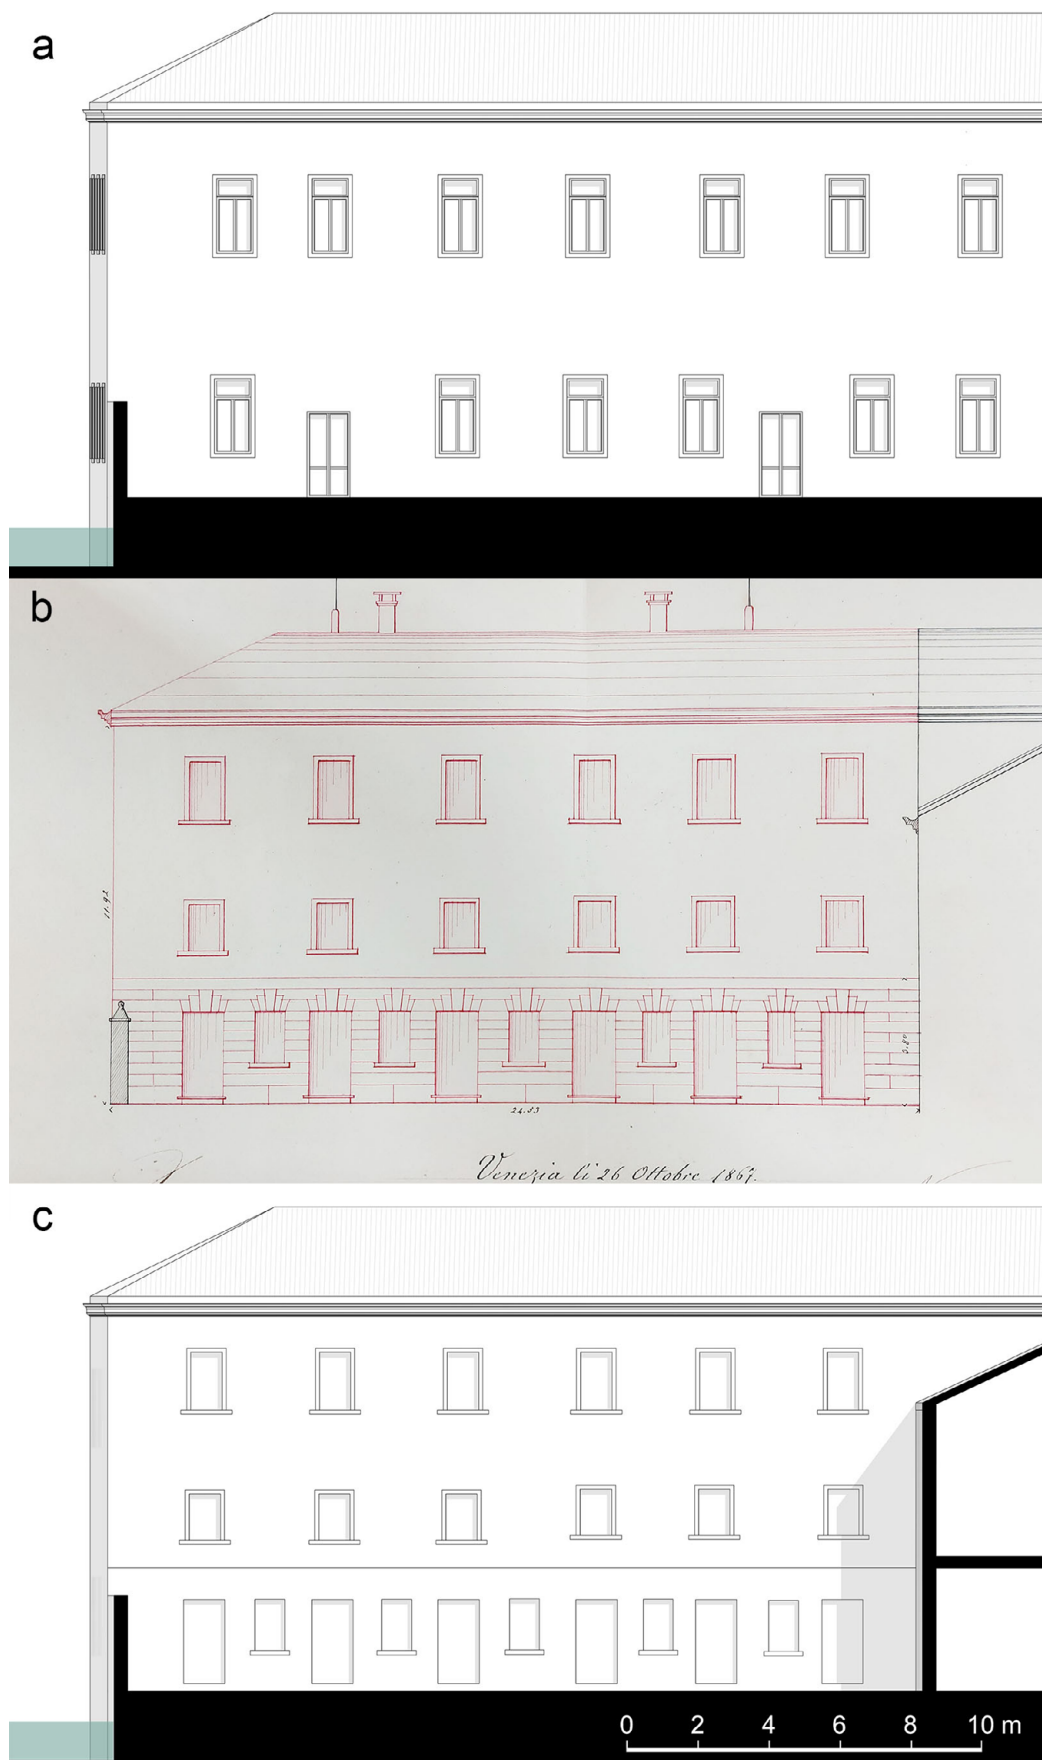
Elaborazione mediante l'utilizzo di un prospetto storico: a) prospetto attuale; b) posizionamento della risorsa iconografica; c) prospetto raffigurante la conformazione dell'edificio nel 1867. Elaborazione dell'autore.
